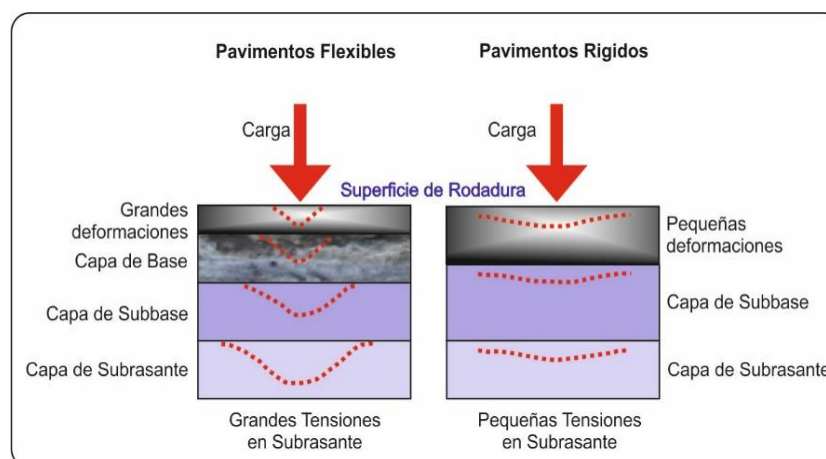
Comportamiento de Pavimentos Flexibles y Rígidos
